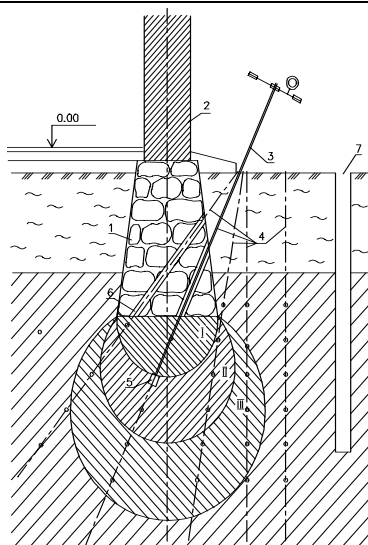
Зондирование лопастным зондом грунтов в основании фундамента: 1 – фундамент; 2 – стена; 3 – зонд; 4 – направления внедрения зонда; 5 – лопастной наконечник; 6 – сквозное отверстие, пробитое в фундаменте перфоратором; 7 – скважина для отбора проб; I, II, III – зоны разной степени уплотнения – упрочнения (точками указаны места испытаний на вращательный срез)
